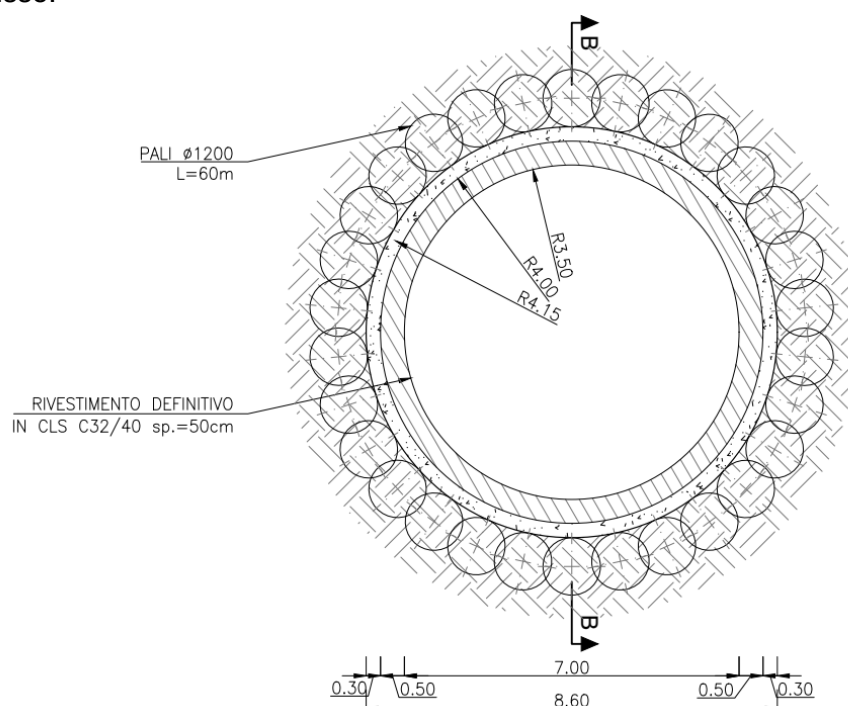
Sezione tipo P-Sb1 del pozzo sbarre
